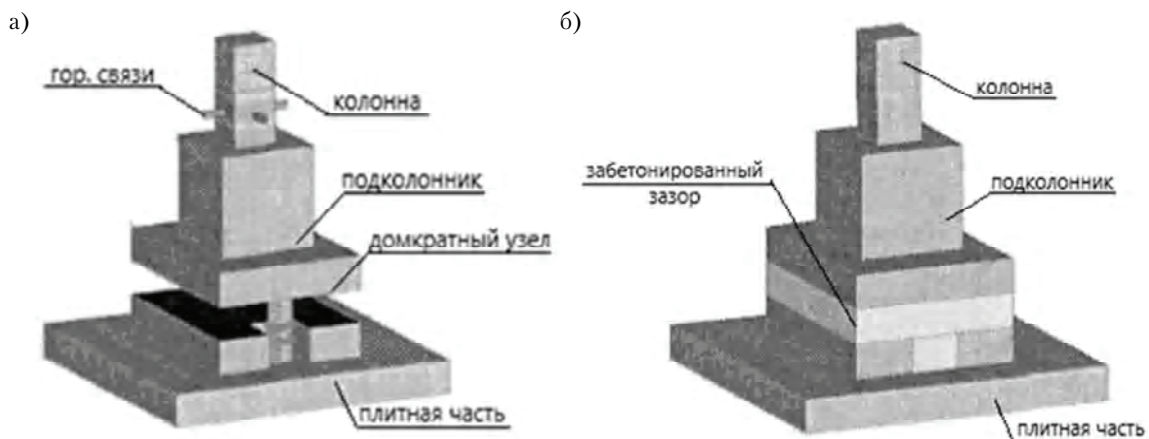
Регулируемый фундамент для проектируемых зданий с железобетонным каркасом в процессе подъема с помощью домкрата: а) подъем и выравнивание здания, б) бетонирование образовавшегося зазора.
